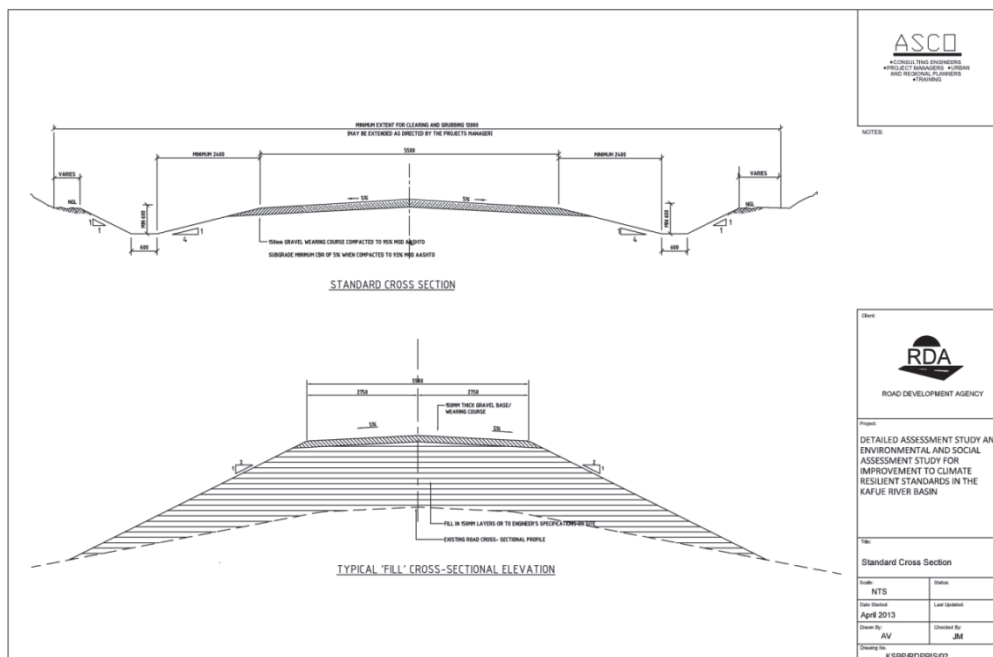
フィーダー道路標準断面図 (RDAより)
